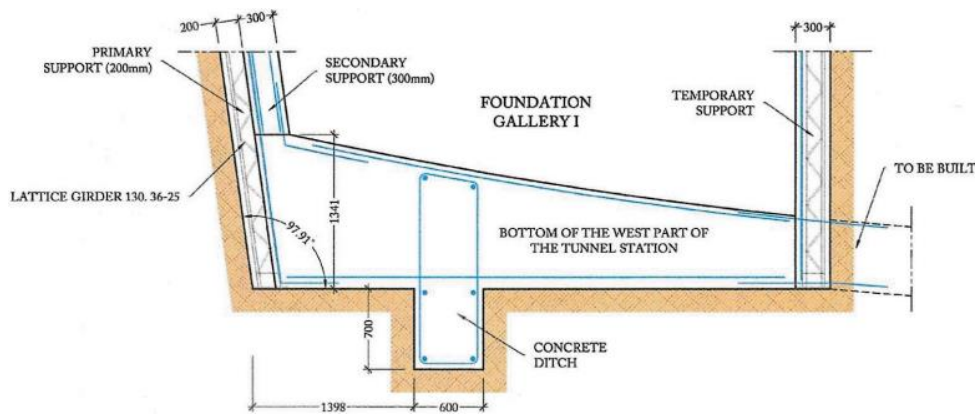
Detalle de la losa de fondo en la galería de cimentación.
